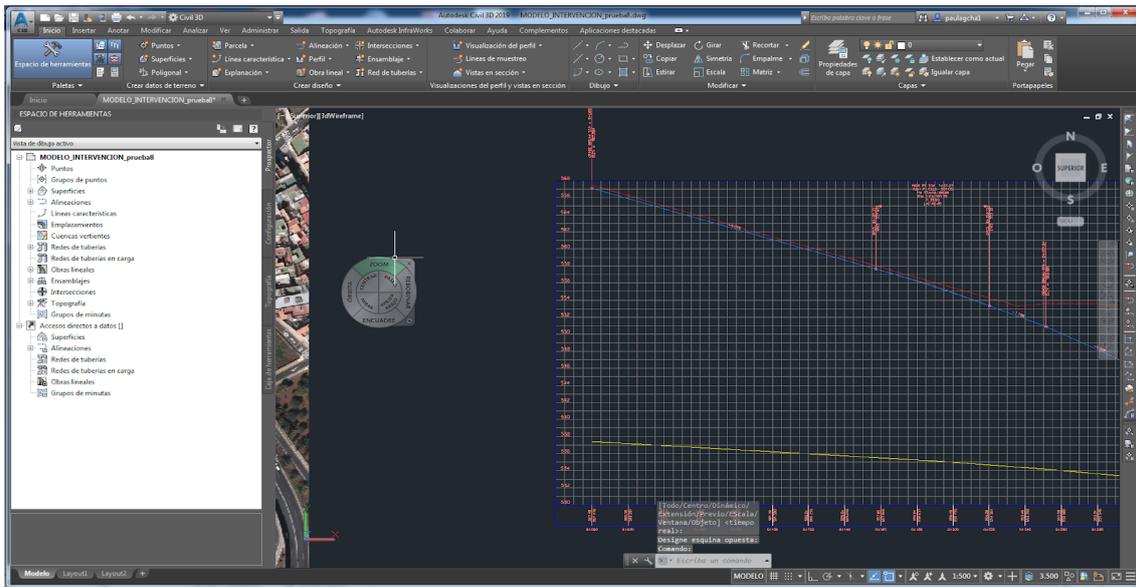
Perfil longitudinal de la TF-24. Fuente: Elaboración propia
